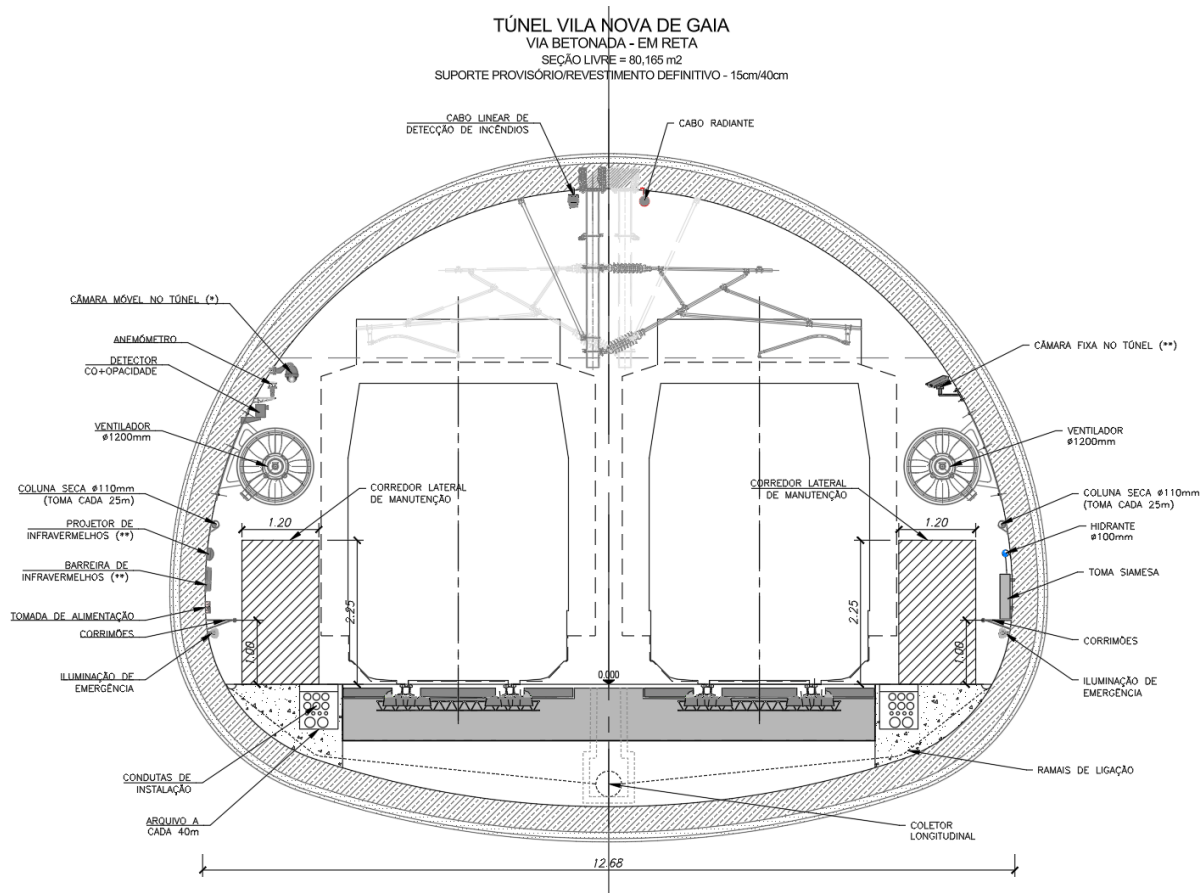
Túnel Vila Nova de Gaia – Via betonada em reta
